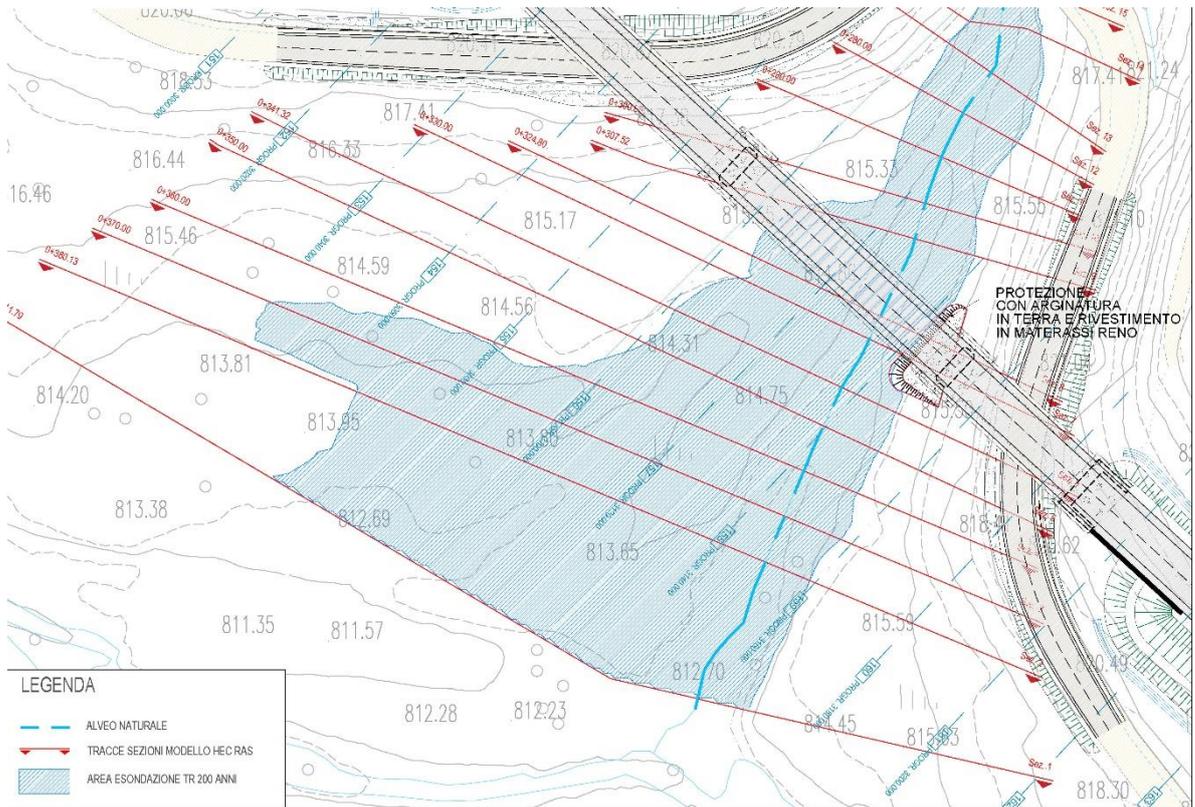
Riu Idolo – Planimetria aree di esondazione.
